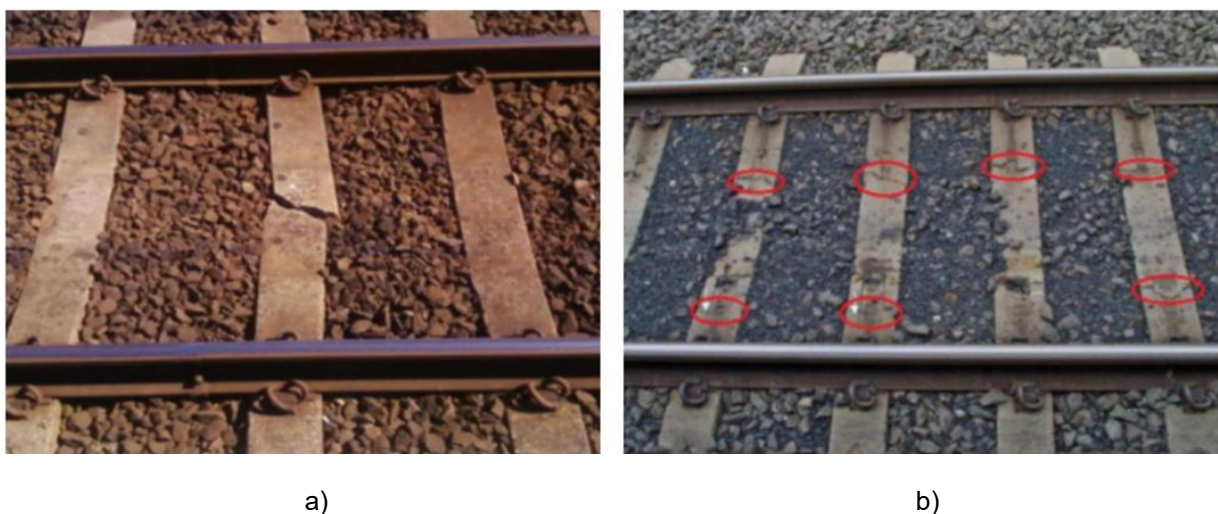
Fissuras em dormentes de concreto devido à carga de impacto
